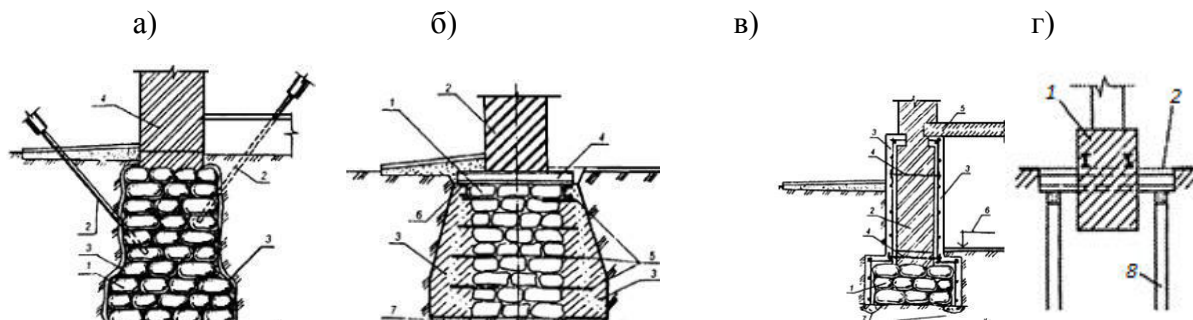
Схеми підсилення фундаментів будівель і споруд: а – цементация через пробурені свердловини; б – добетонування; в – улаштування залізобетонних обойм.
